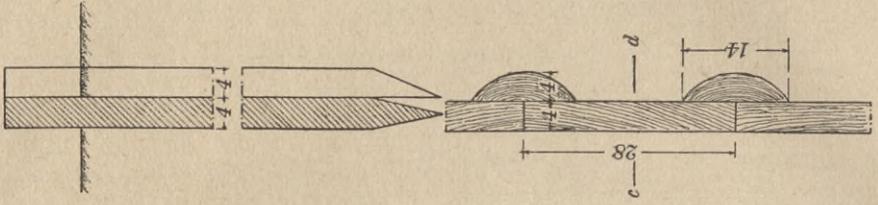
Stülpwand mit Fugendeckung durch Schwarten.
